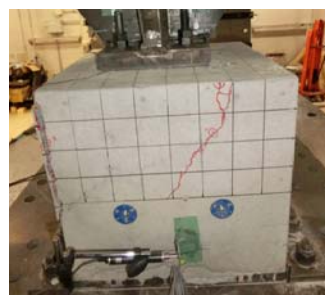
破壊状況 繰返し載荷実験 単試験体
